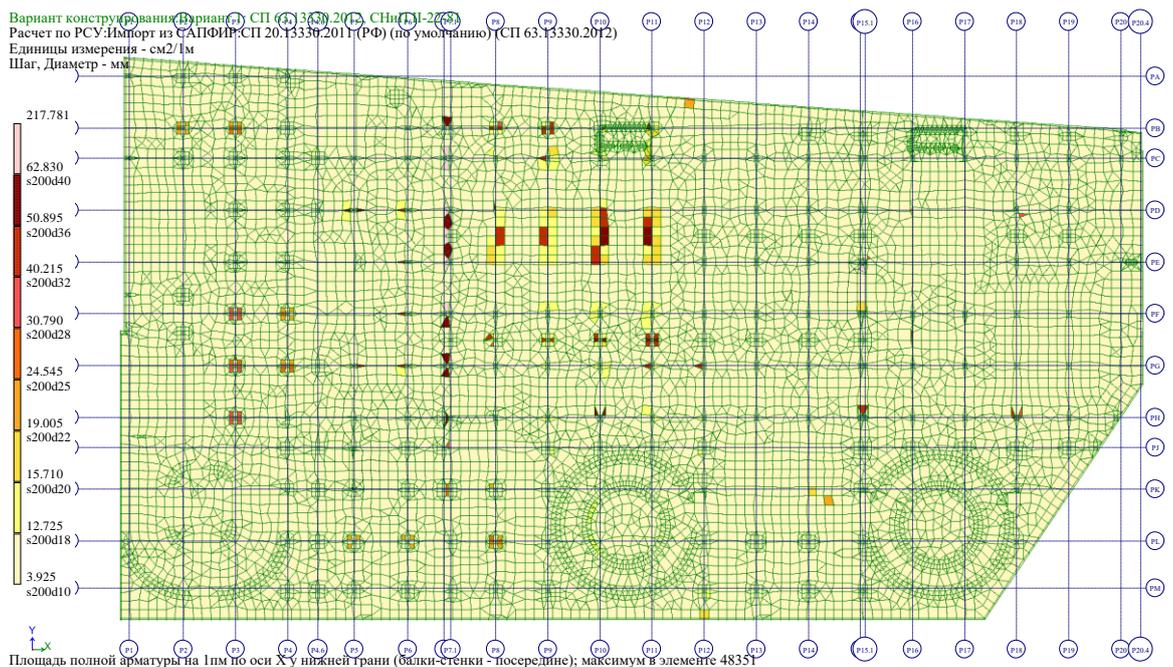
Армирование фундаментной плиты. Площадь полной арматуры на 1м по оси X у верхней грани
